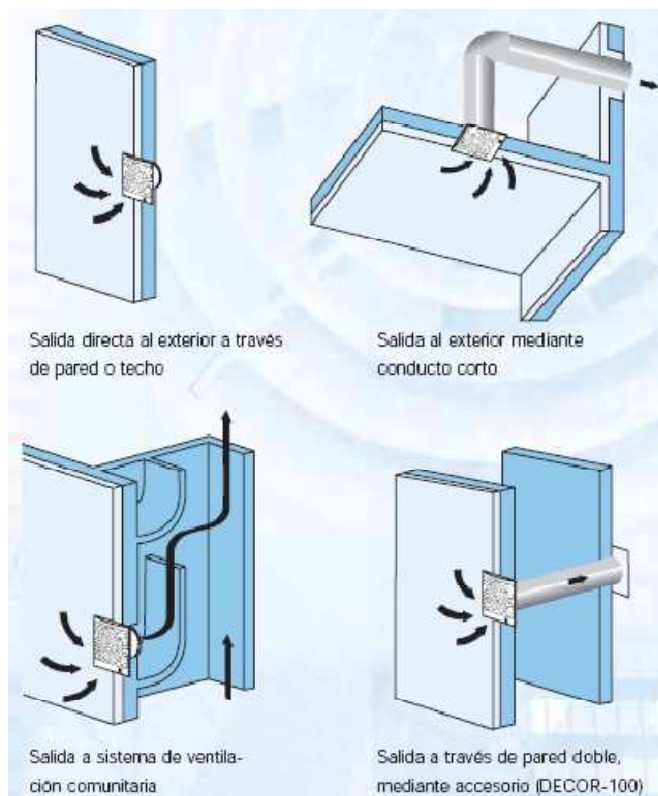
Instalación al exterior ventiladores serie Decor.
